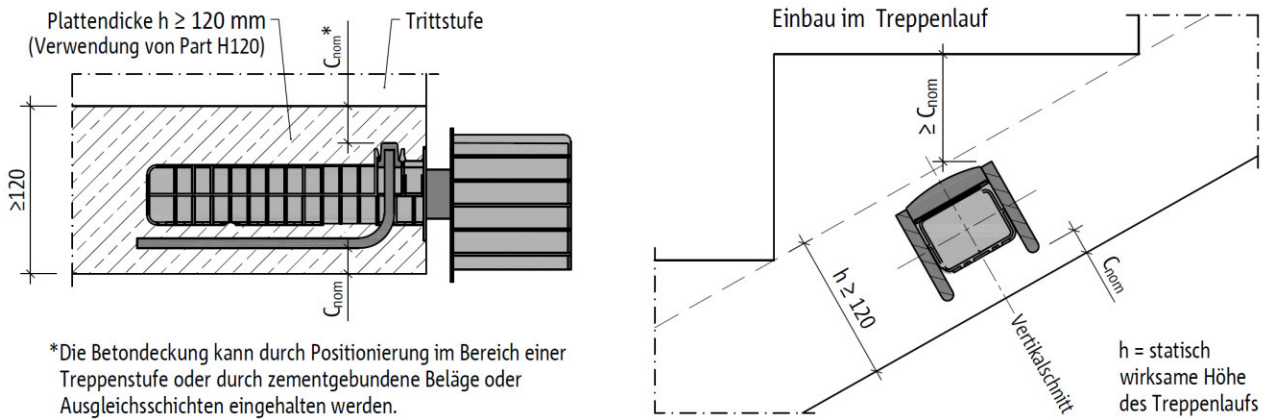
Betonüberdeckung Schöck Tronsole® Typ Q (Quelle: Z-15.7-311 [11])
